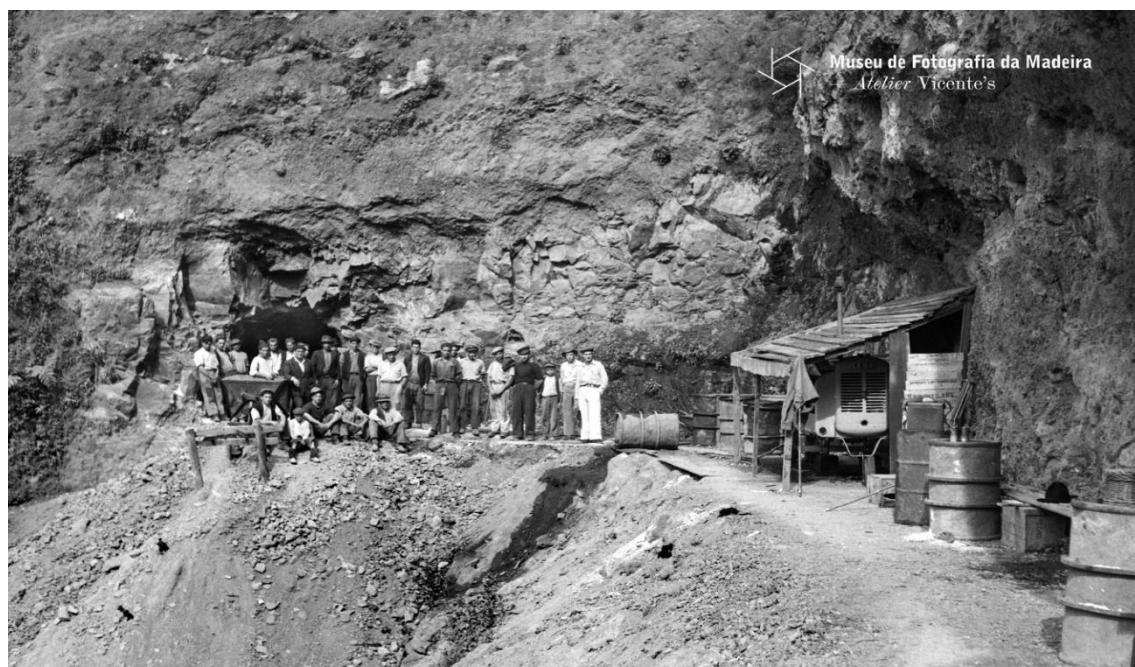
Construção da Levada do Norte, 1952/ABM. Fonte: <https://enr.pw/culturamadeira>
